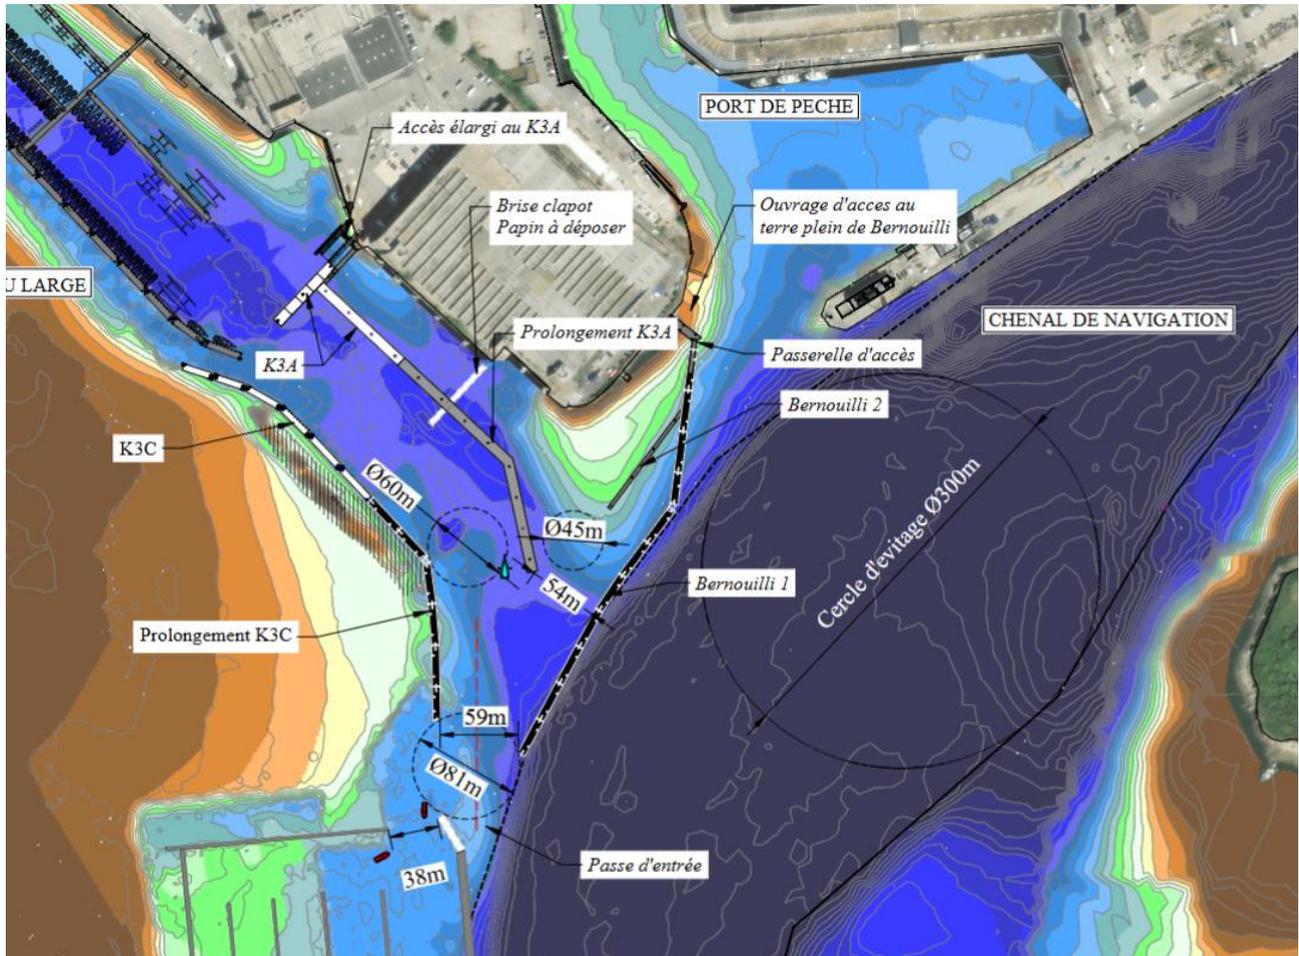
PLAN D'AMENAGEMENT DES OUVRAGES A CREER
